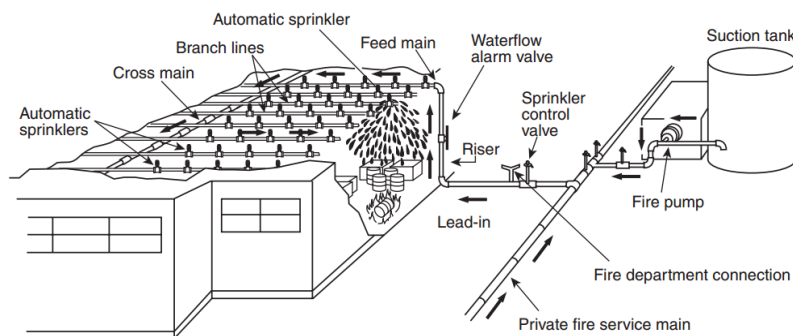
Instalação tipo de um sistema de extinção por sprinklers [32]
